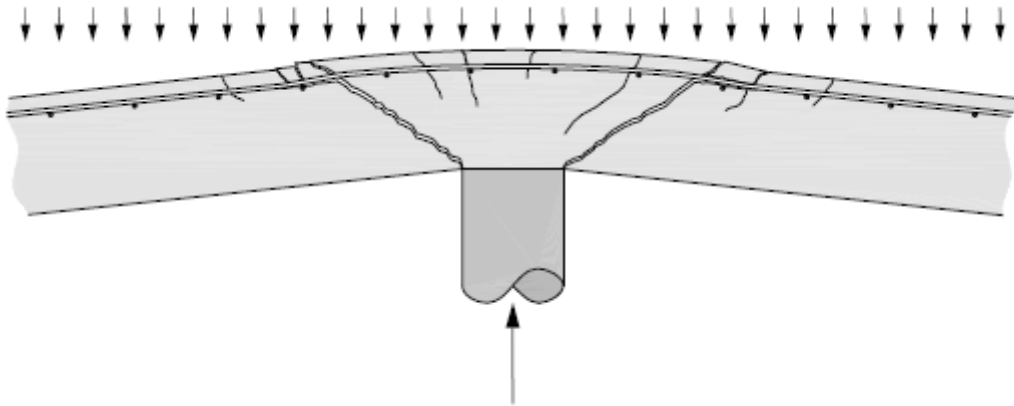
Rupture par poinçonnement d'un plancher-dalle en béton armé (image prise de la thèse N° 4812 (2010) EPFL)
